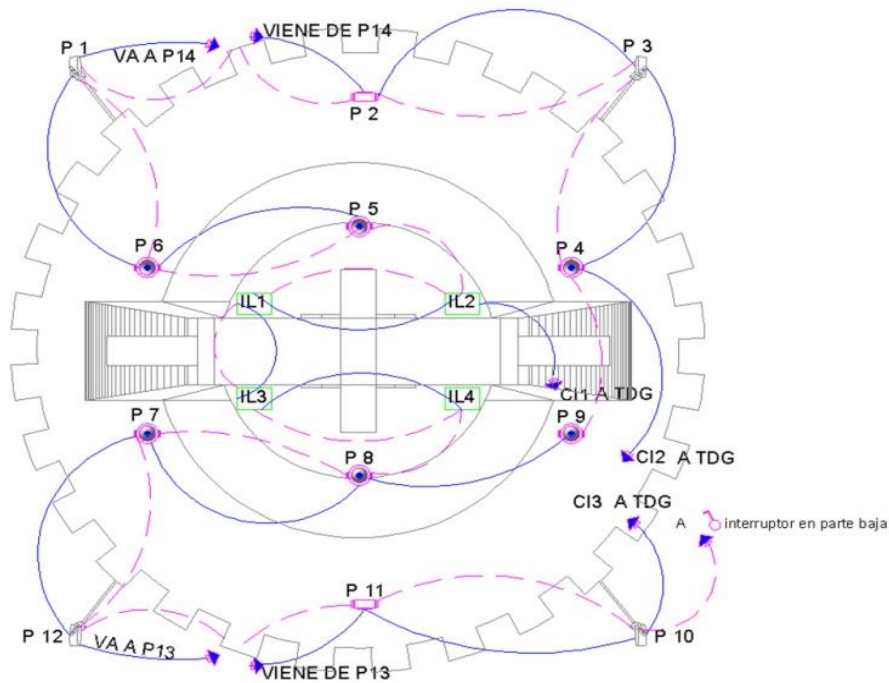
Esquema de conexión de los proyectores en la cruz, vista de planta.
